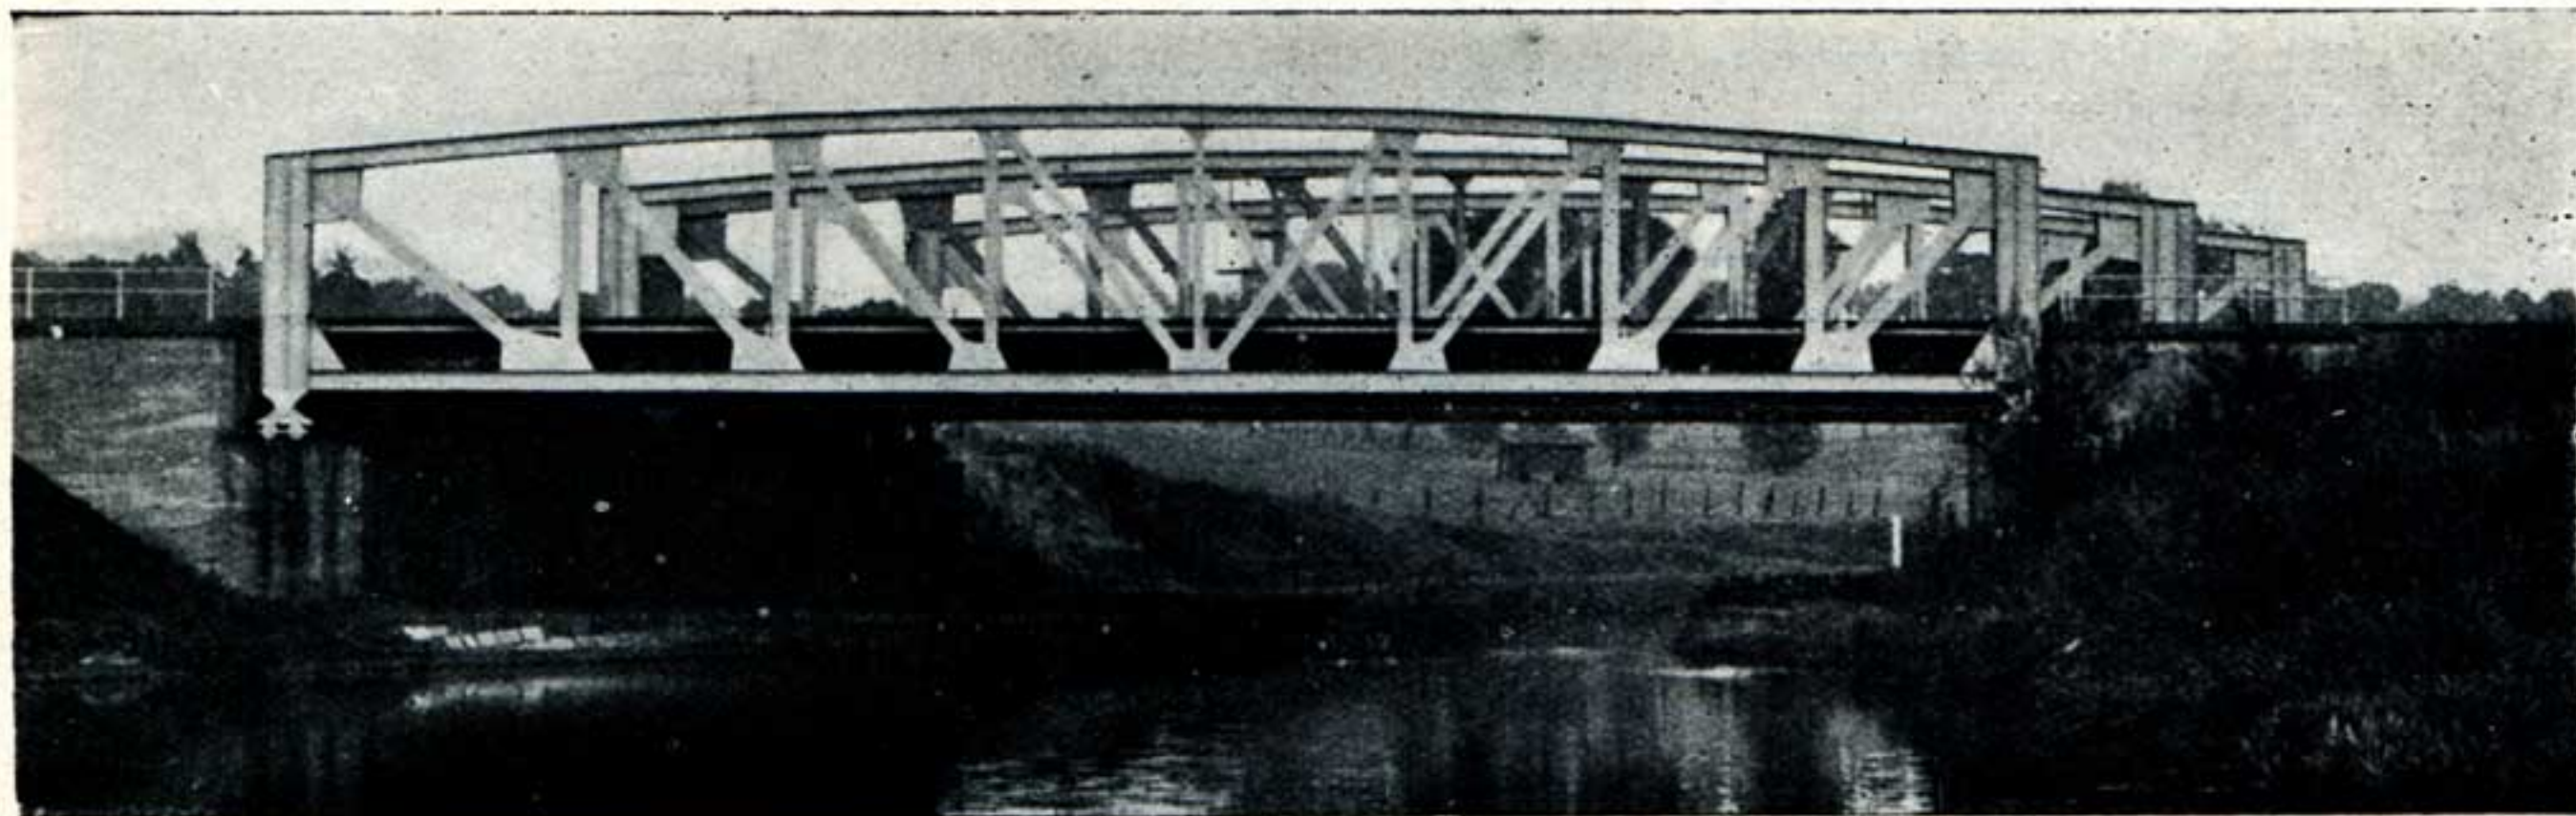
Entre Courcelles Motte et La Chaussée. — Nouveau pont au-dessus du canal.
